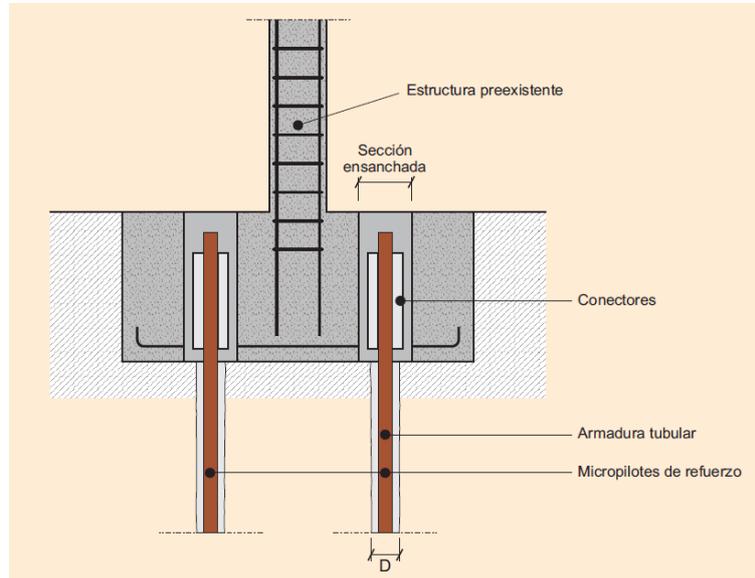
Ejemplo de conexión directa a un cimiento de hormigón armado. “Guía para el proyecto y la ejecución de micropilotes en obras de carreteras”, Dirección general de carreteras, Ministerio de Fomento, 2005.
